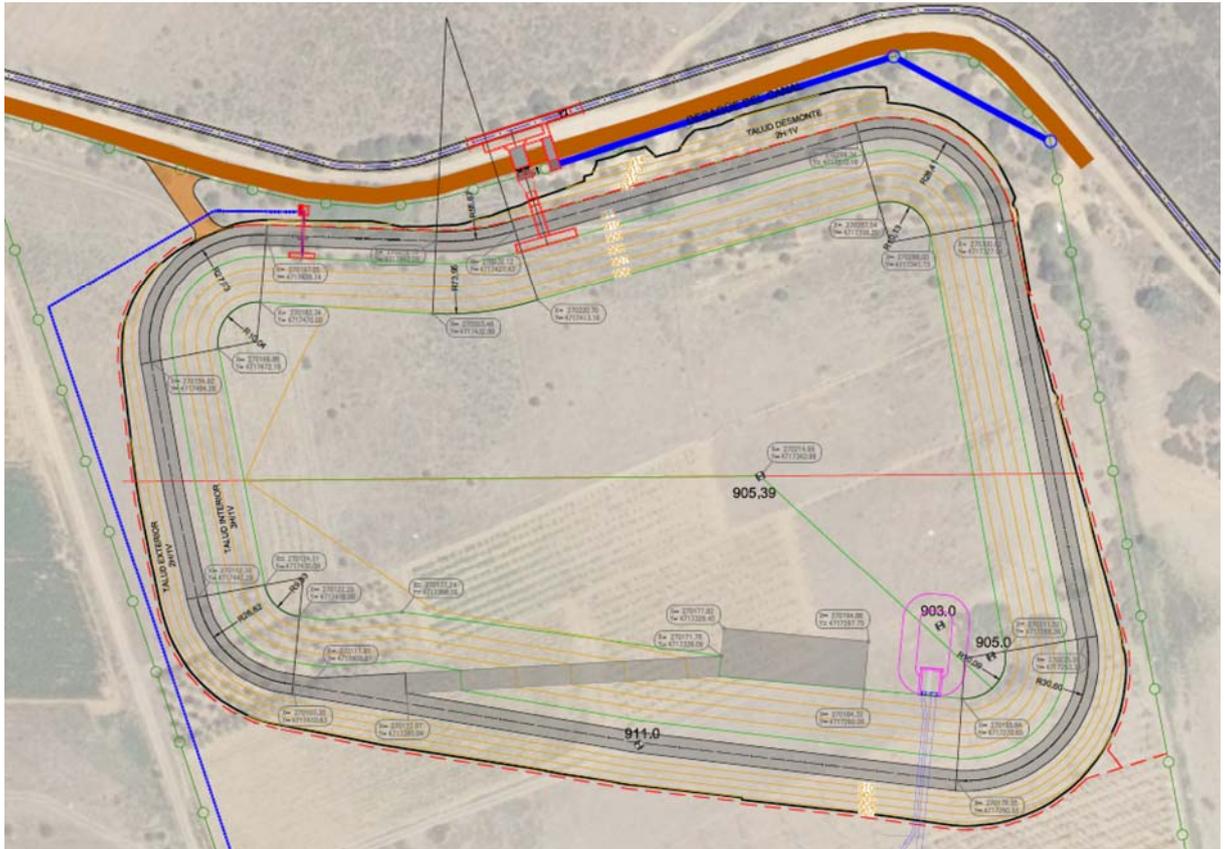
Planta general de la balsa diseñada. Fuente: plano nº 21.1 Balsa de regulación. Planta general
